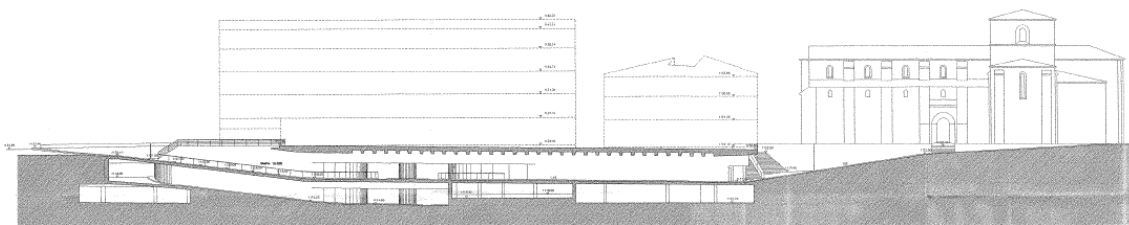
Plano de secciones de la Plaza de Santa Teresa y de la Unidad de Ejecución 76/1. Plan Especial de Reforma Interior Mercado Grande de Ávila (2000)
